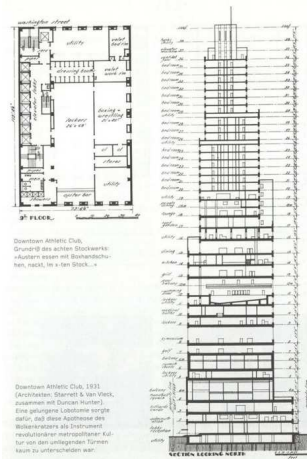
Starrett & Van Vleck, *Downtown Athletic Club* (1931). Planta 9 y sección.
